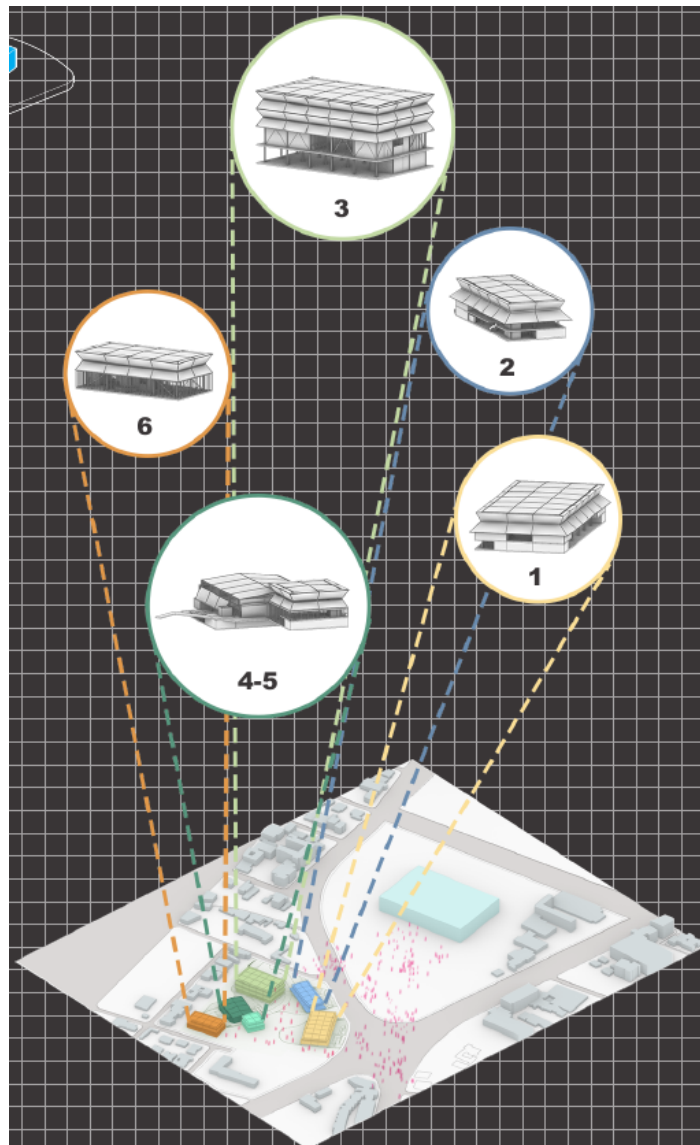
Emplazamiento de cada bloque, Fuente: Elaboración propia
